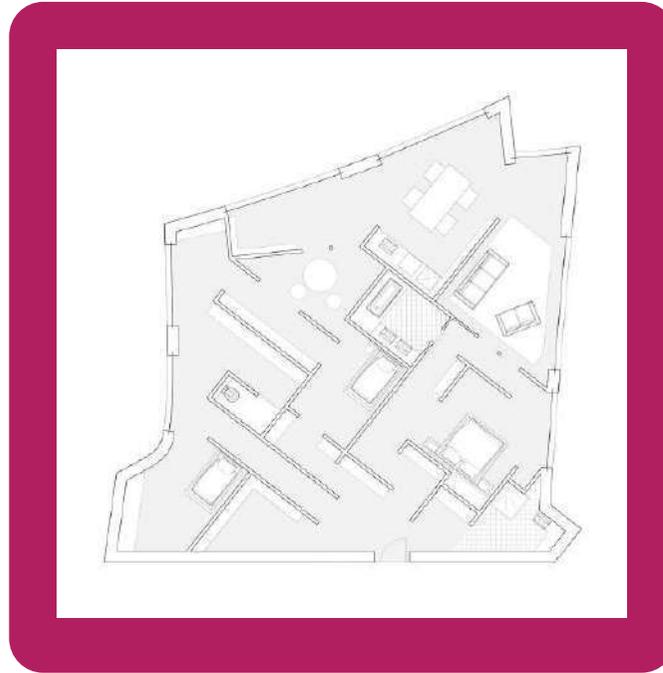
Planta arquitectónica proyecto con IA de Stanislas Chaillou.
